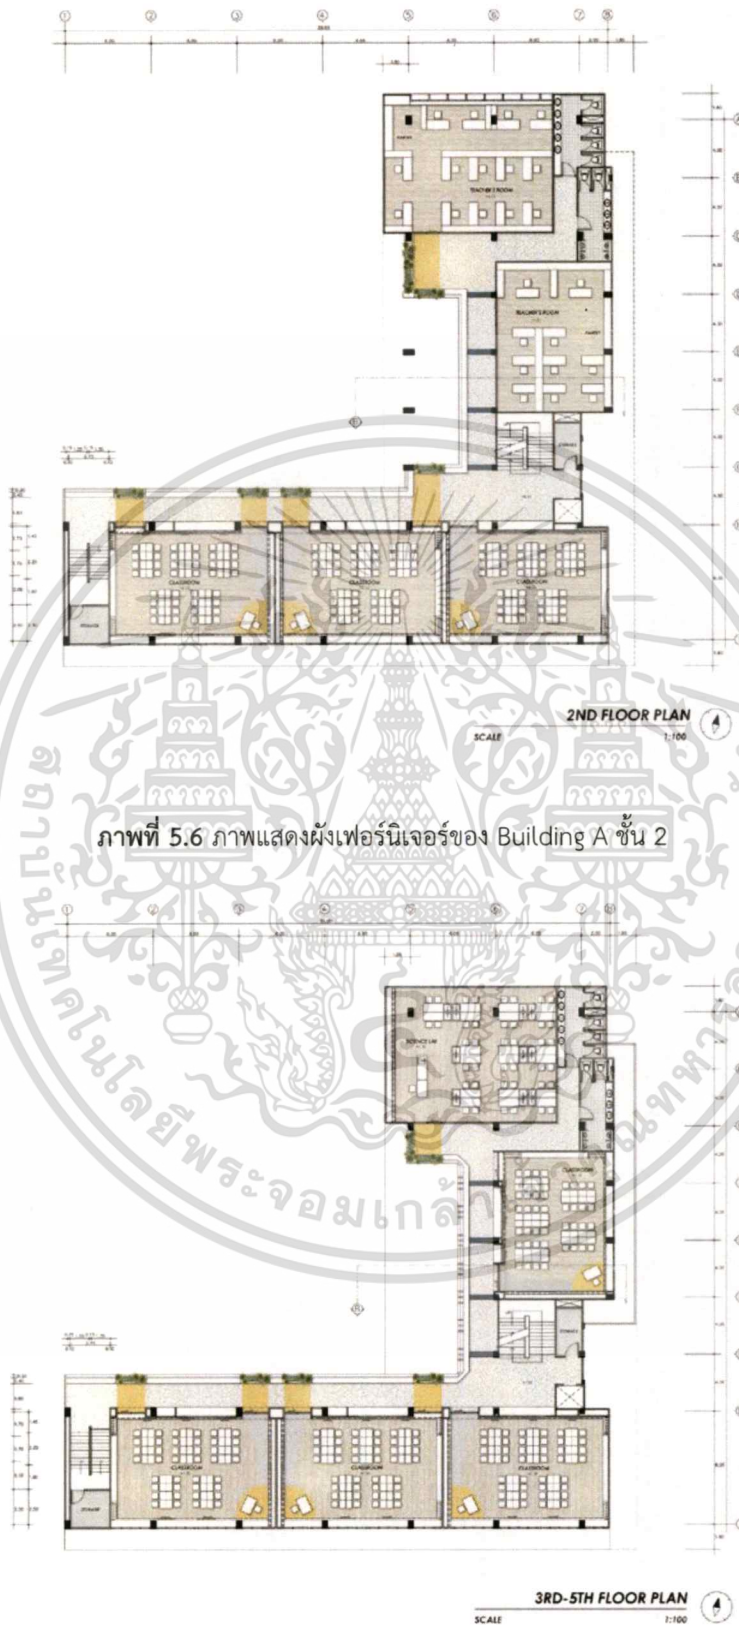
ภาพแสดงผังเฟอร์นิเจอร์ของ Building A ชั้น 3
